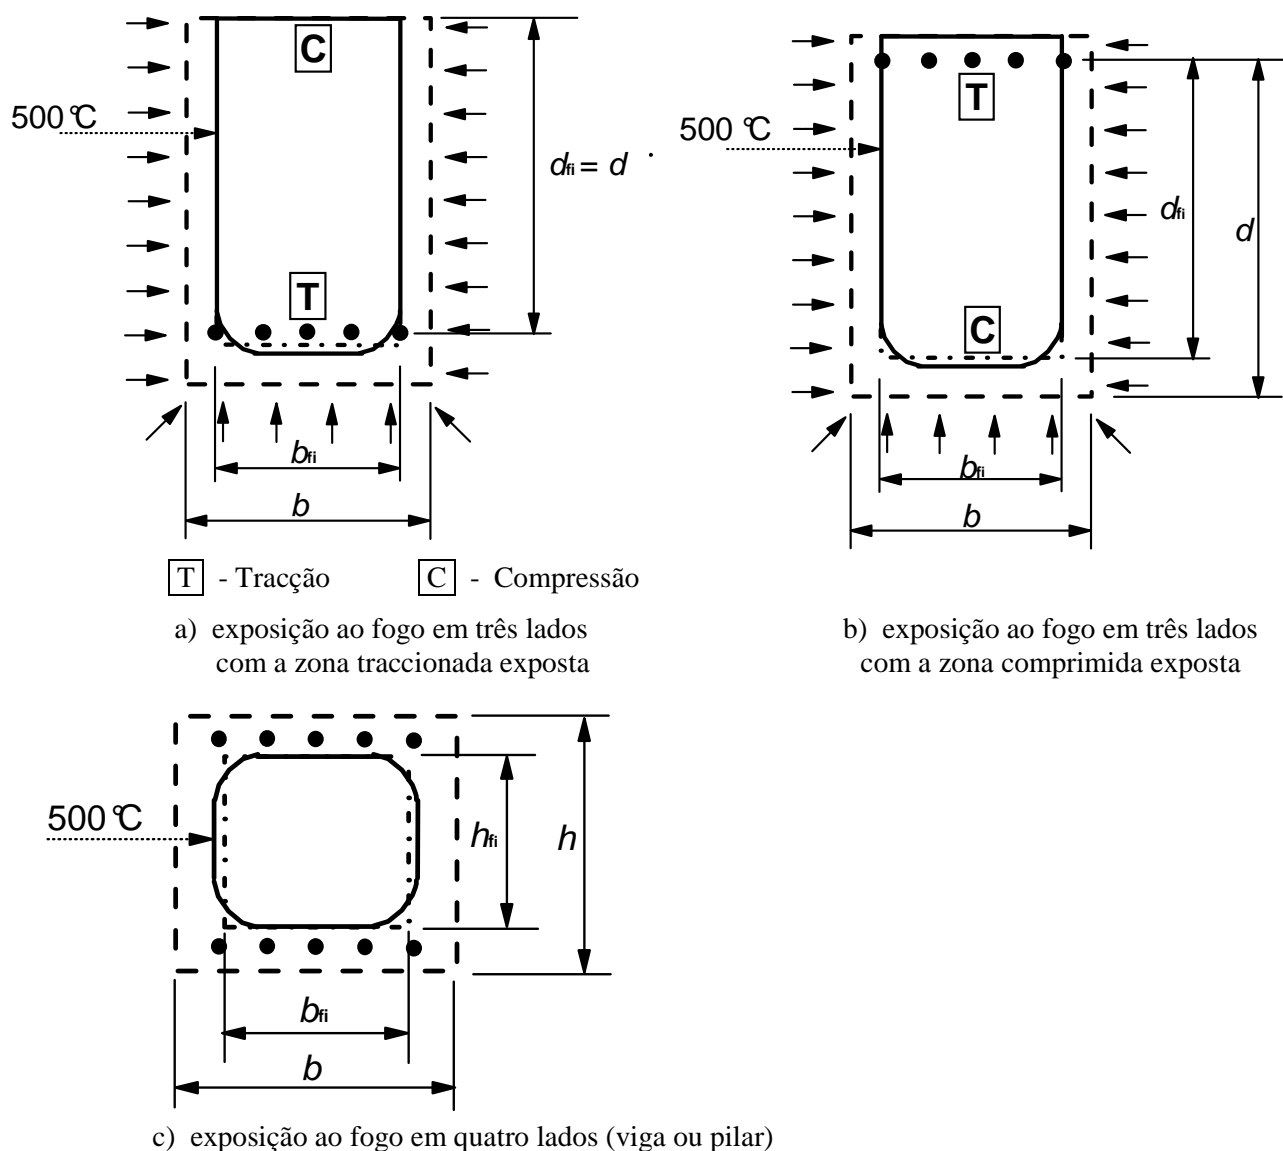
Secção transversal reduzida de viga ou de pilar de betão armado
